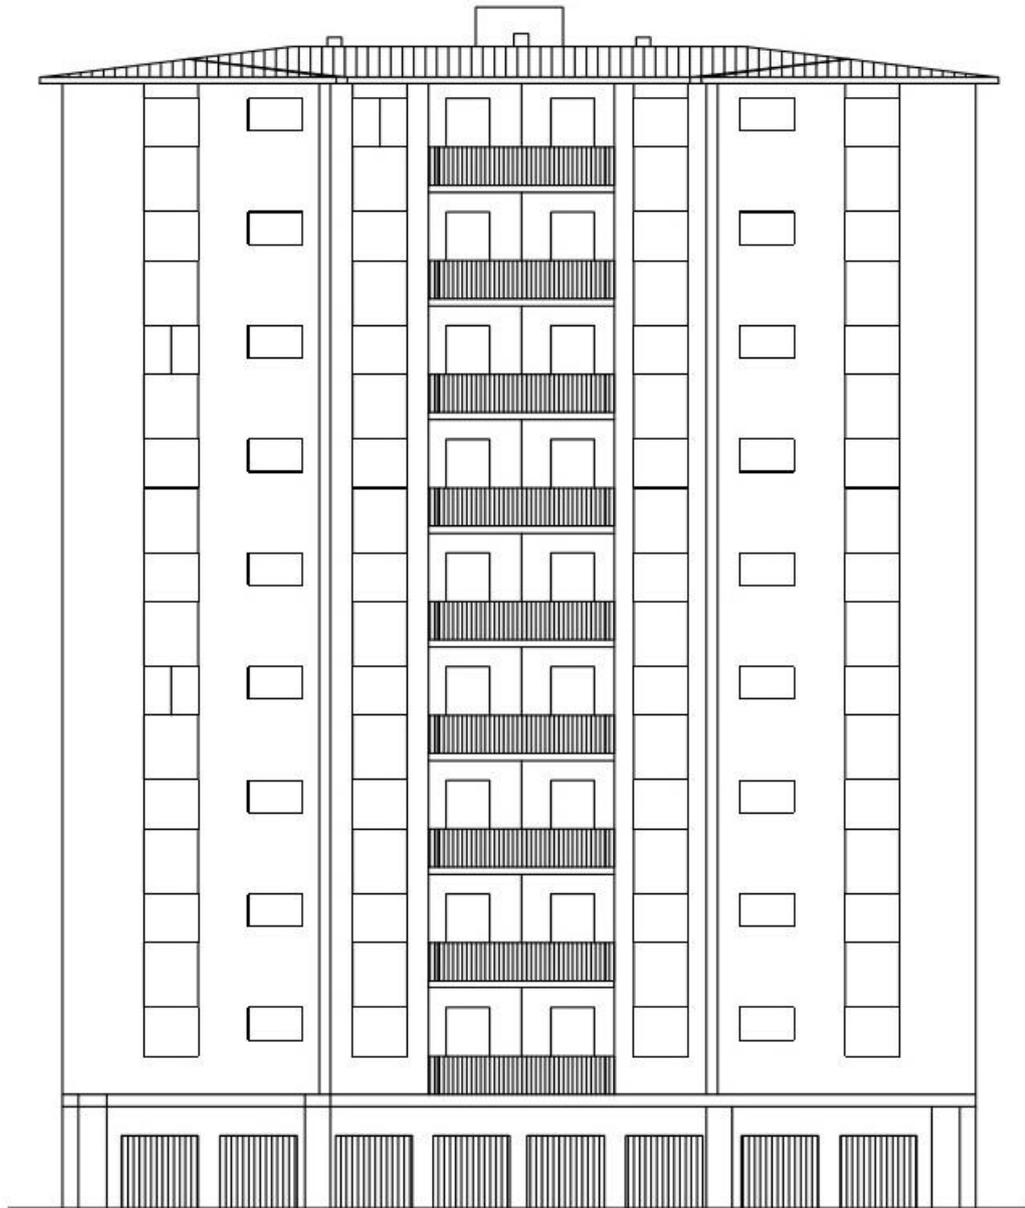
Prospetto Ovest, via Brofferio 1. Scala 1:200. Fonte: Ater Padova.
